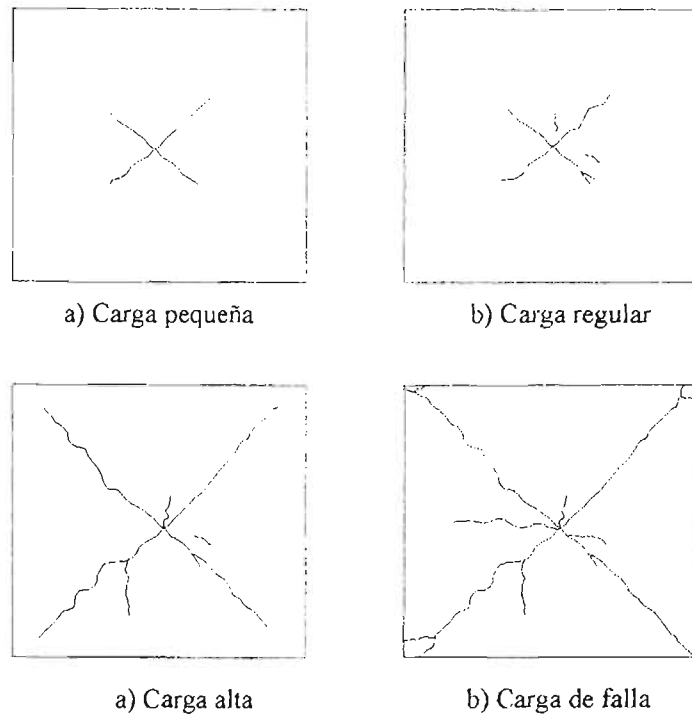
Agrietamientos para distintos valores de carga aplicada a una losa.
